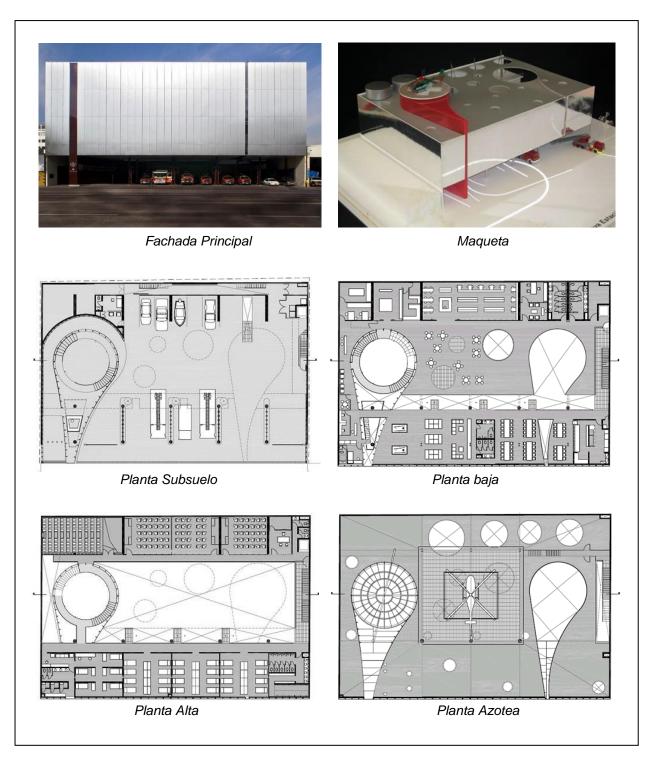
Fachadas, maquetas y plantas de la Estación de Bomberos.
